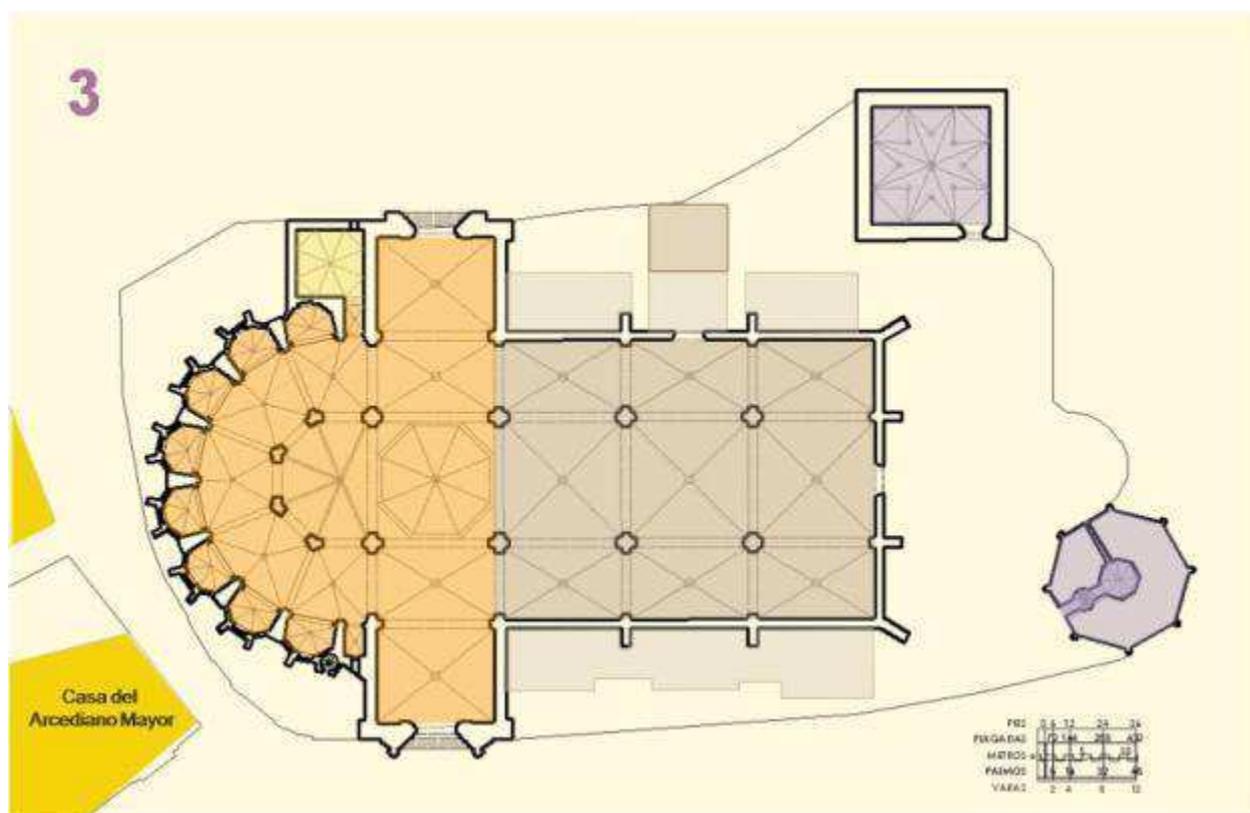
12.3 Evolución constructiva. Fase 3 / Planta <sup>302</sup>
